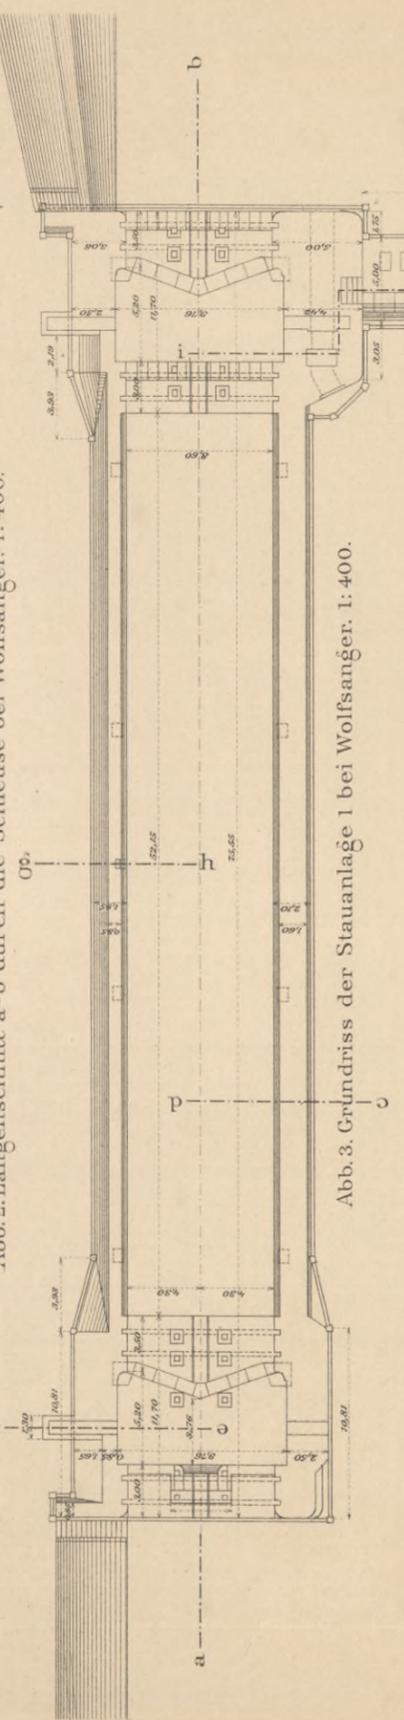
Grundriss der Stauanlage 1 bei Wolfsanger. 1:400.
